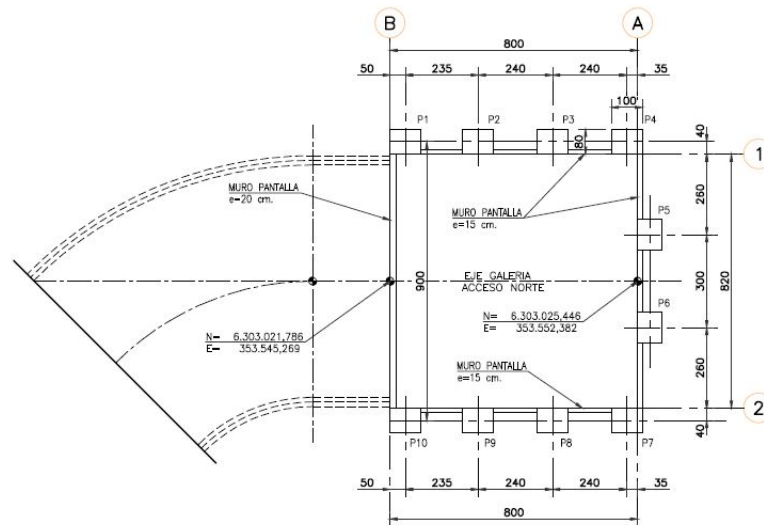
Vista en planta de ejemplo de excavación tipo del estudio.
